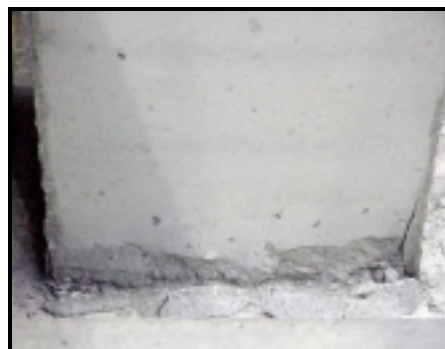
(f) - Fissuração da face traccionada do modelo M6G1.
